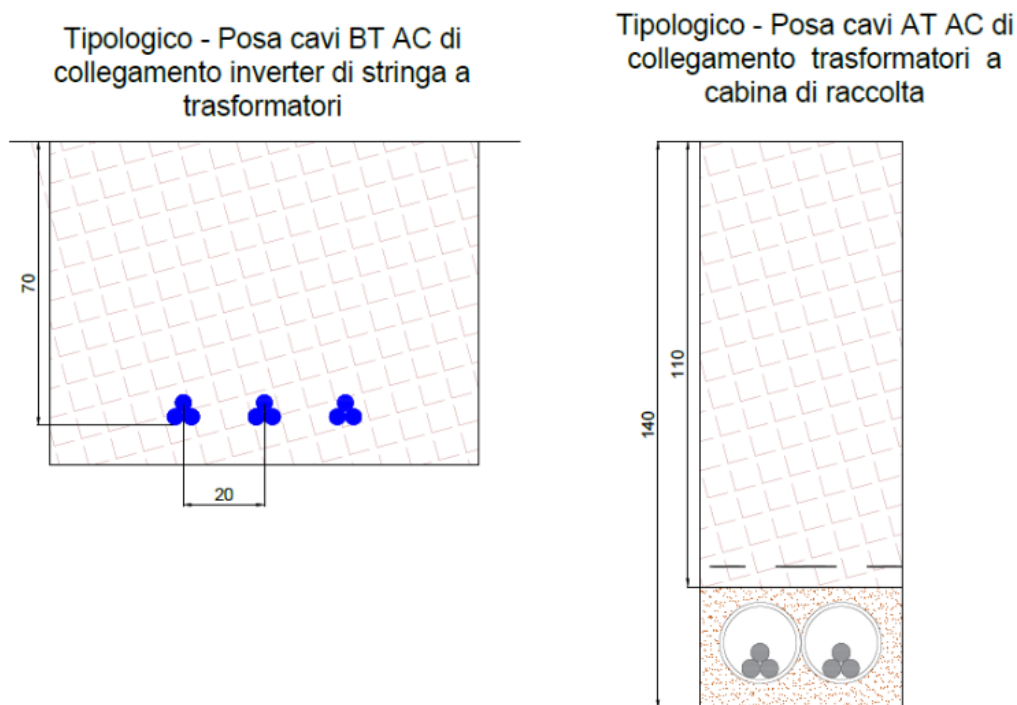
tipologia sezione scavo posa cavidotti BT e AT
